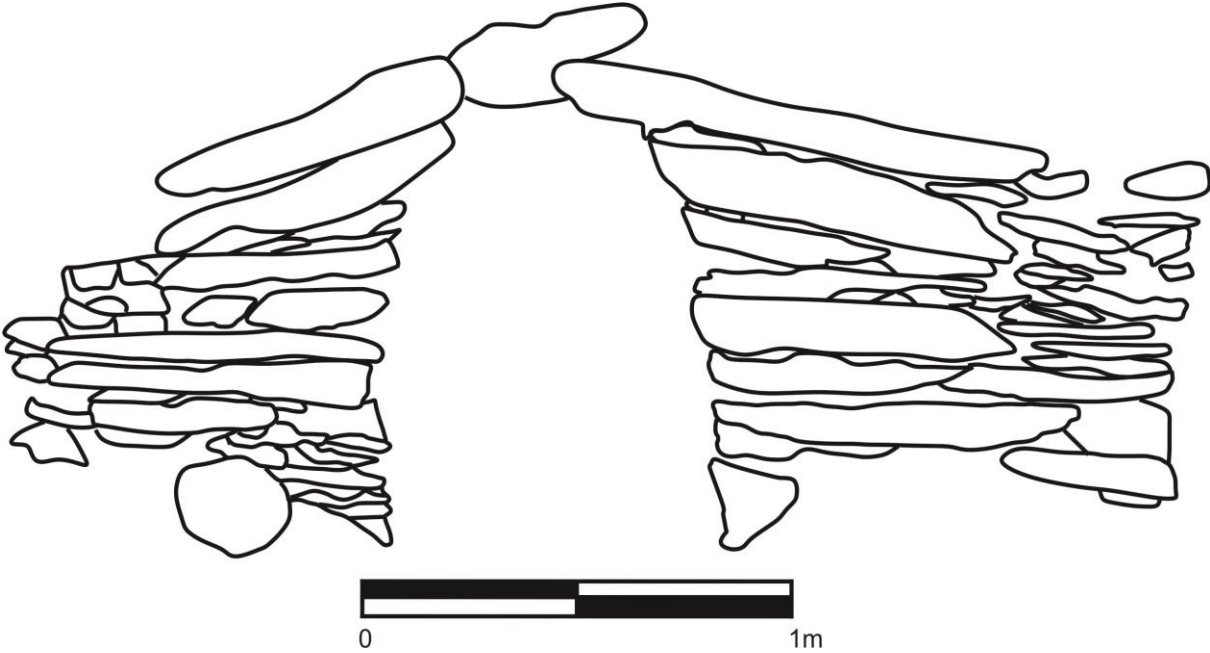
véase el tipo de construcción en la fachada de la chullpa.
